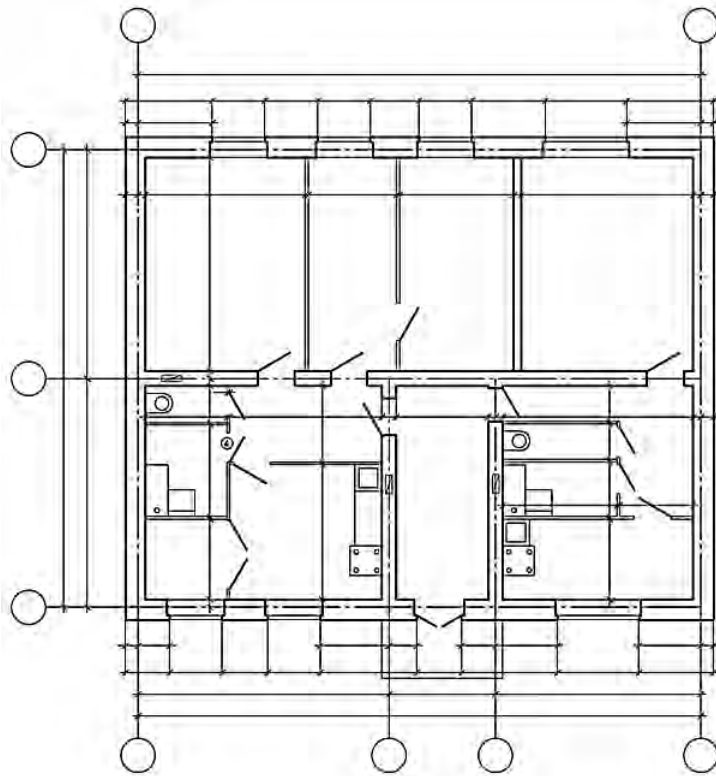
Третий этап выполнения плана. Вычерчивание оконных и дверных проемов в капитальных стенах и перегородках, размещение сантехники и вентканалов
